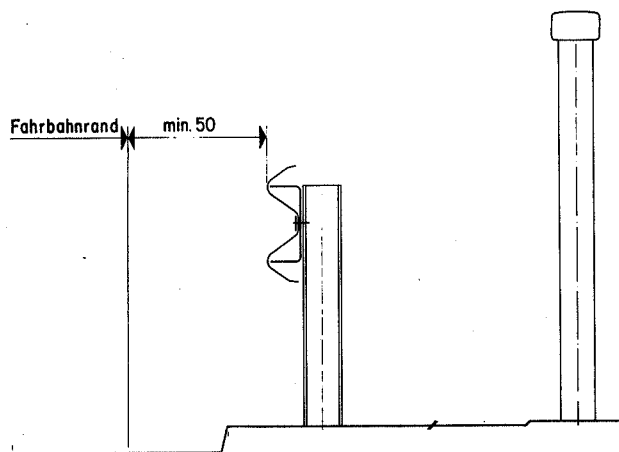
, Brückenrand mit Gehweg und mit Leitschranke am innern Gehwegrand
